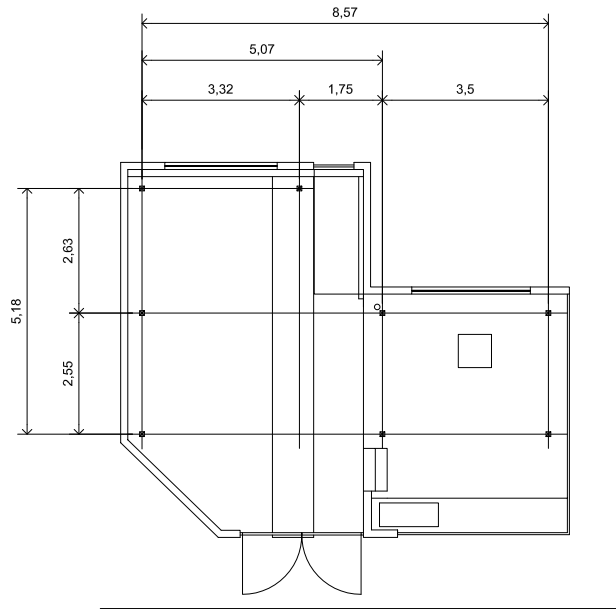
Plano referencial de la estructura cobertizo a considerar en el proyecto. Aporte de “UKUN Ingeniería SpA”.
